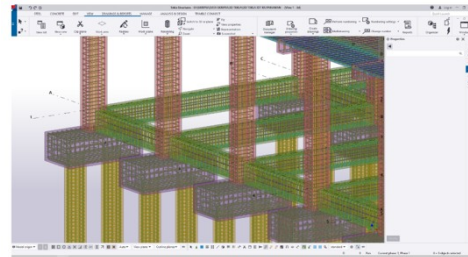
Pondasi Borepile, Pilecap dan Plat Setempat
